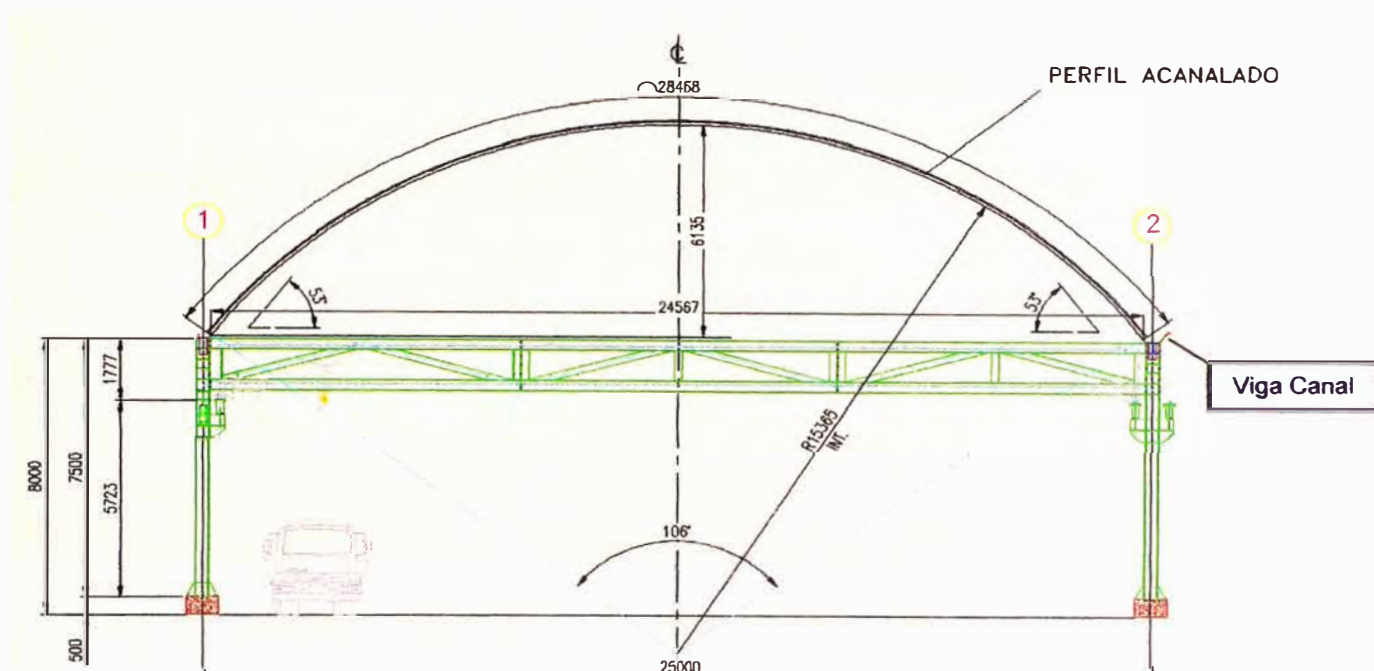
Vista de Elevación del Techo Auto Soportado
